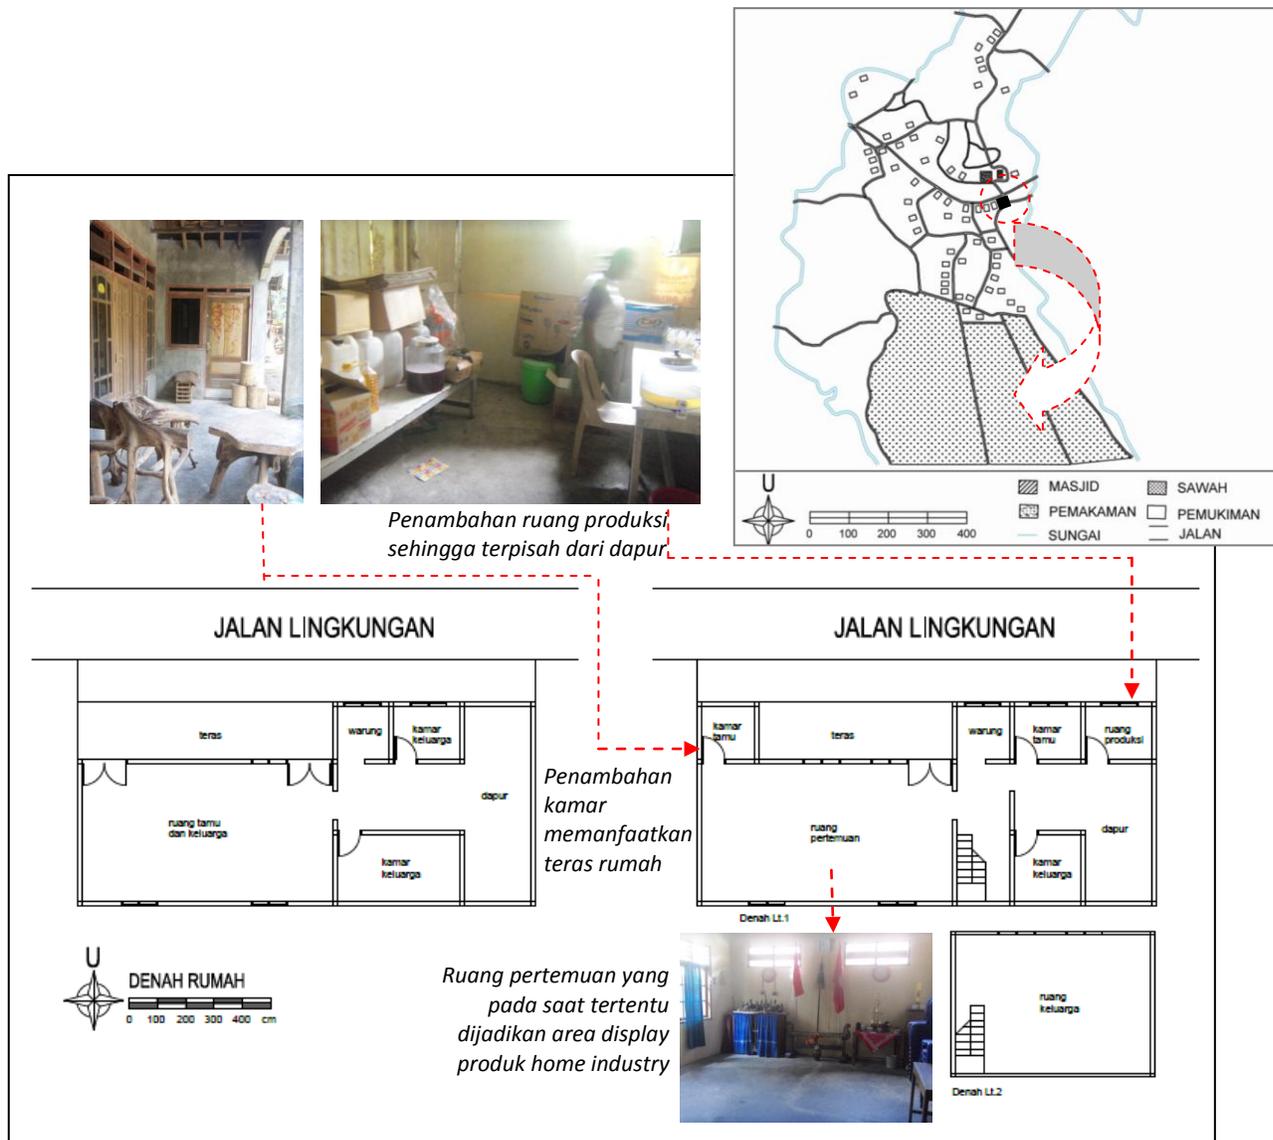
Rumah Pak Rahmat yang mengubah arah hadap rumah menyesuaikan jalan lingkungan yang sedang berkembang
